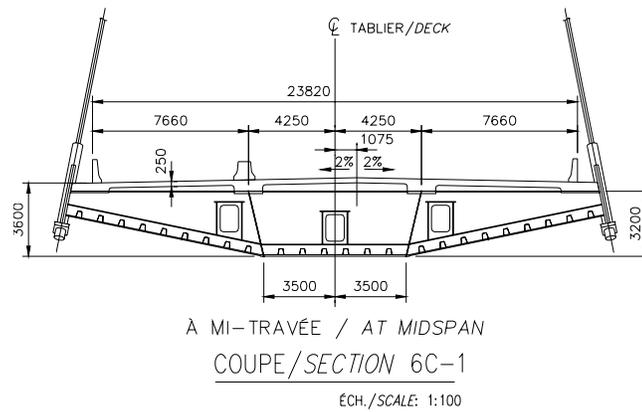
Coupe transversale – Pont à haubans – Solution caisson fermé
